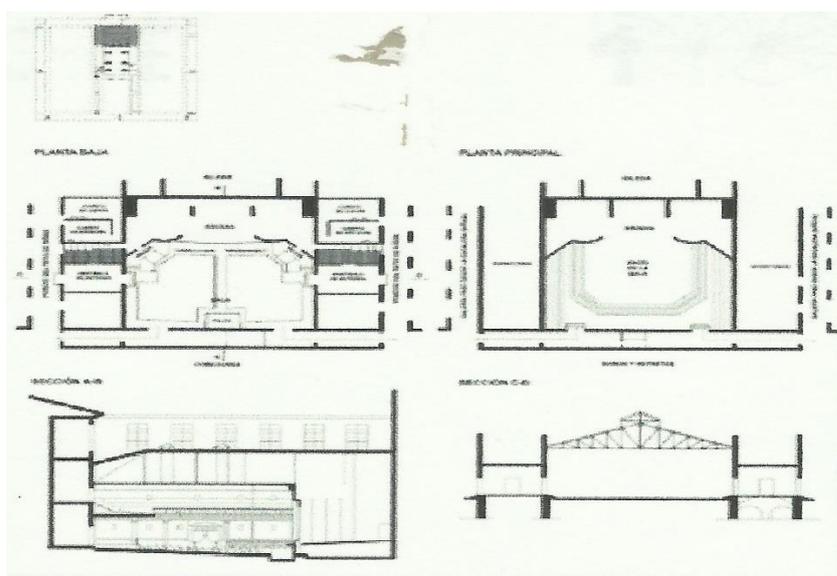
Plano de ubicación, planta baja y secciones del teatro proyectado en 1929.
